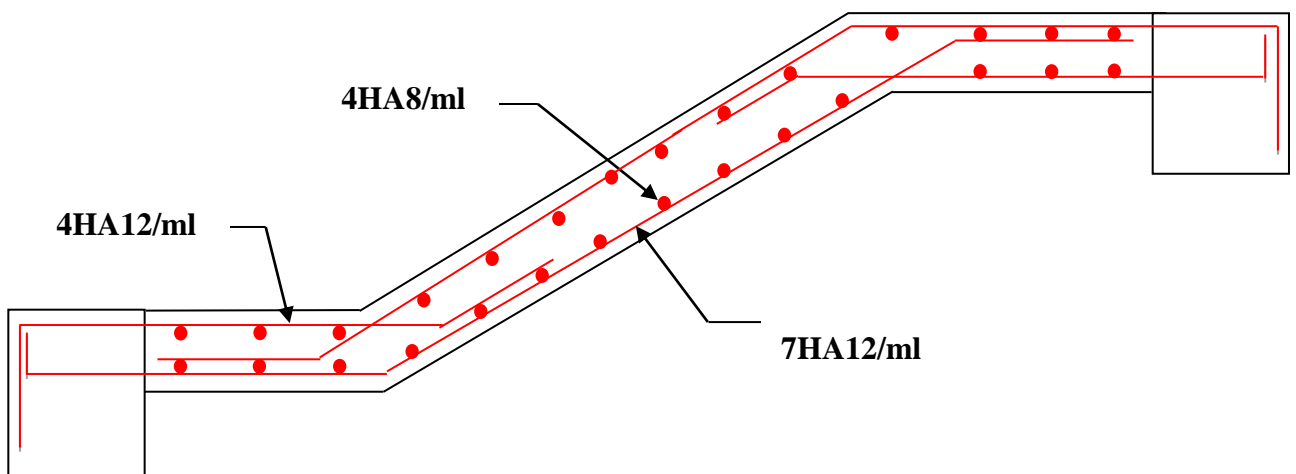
Schéma de ferrailage de l'escalier type (2)
